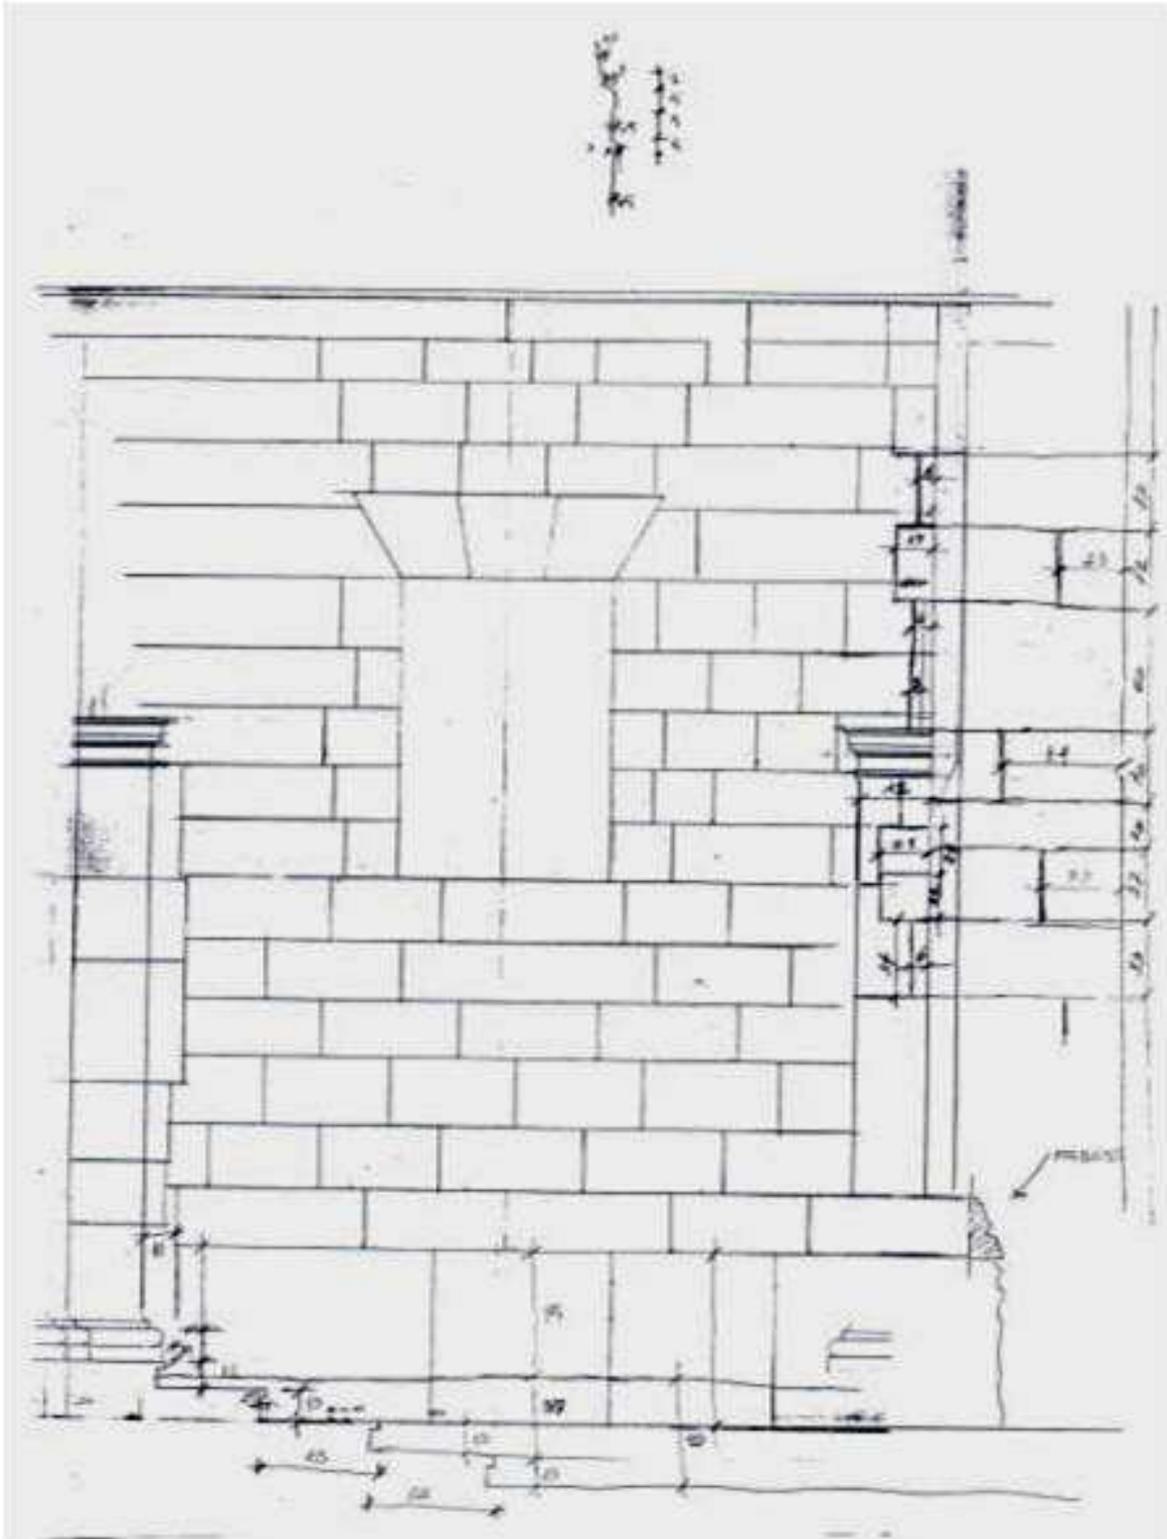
24.4 Toma de datos del despiece de sillares y pilastras del tramo recto de planta baja.
